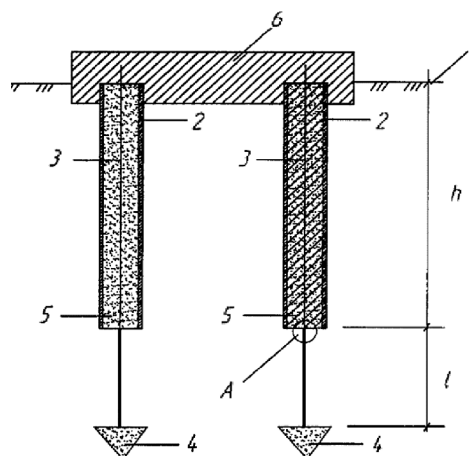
Поперечный разрез опорно-анкерного фундамента в рабочем положении:
